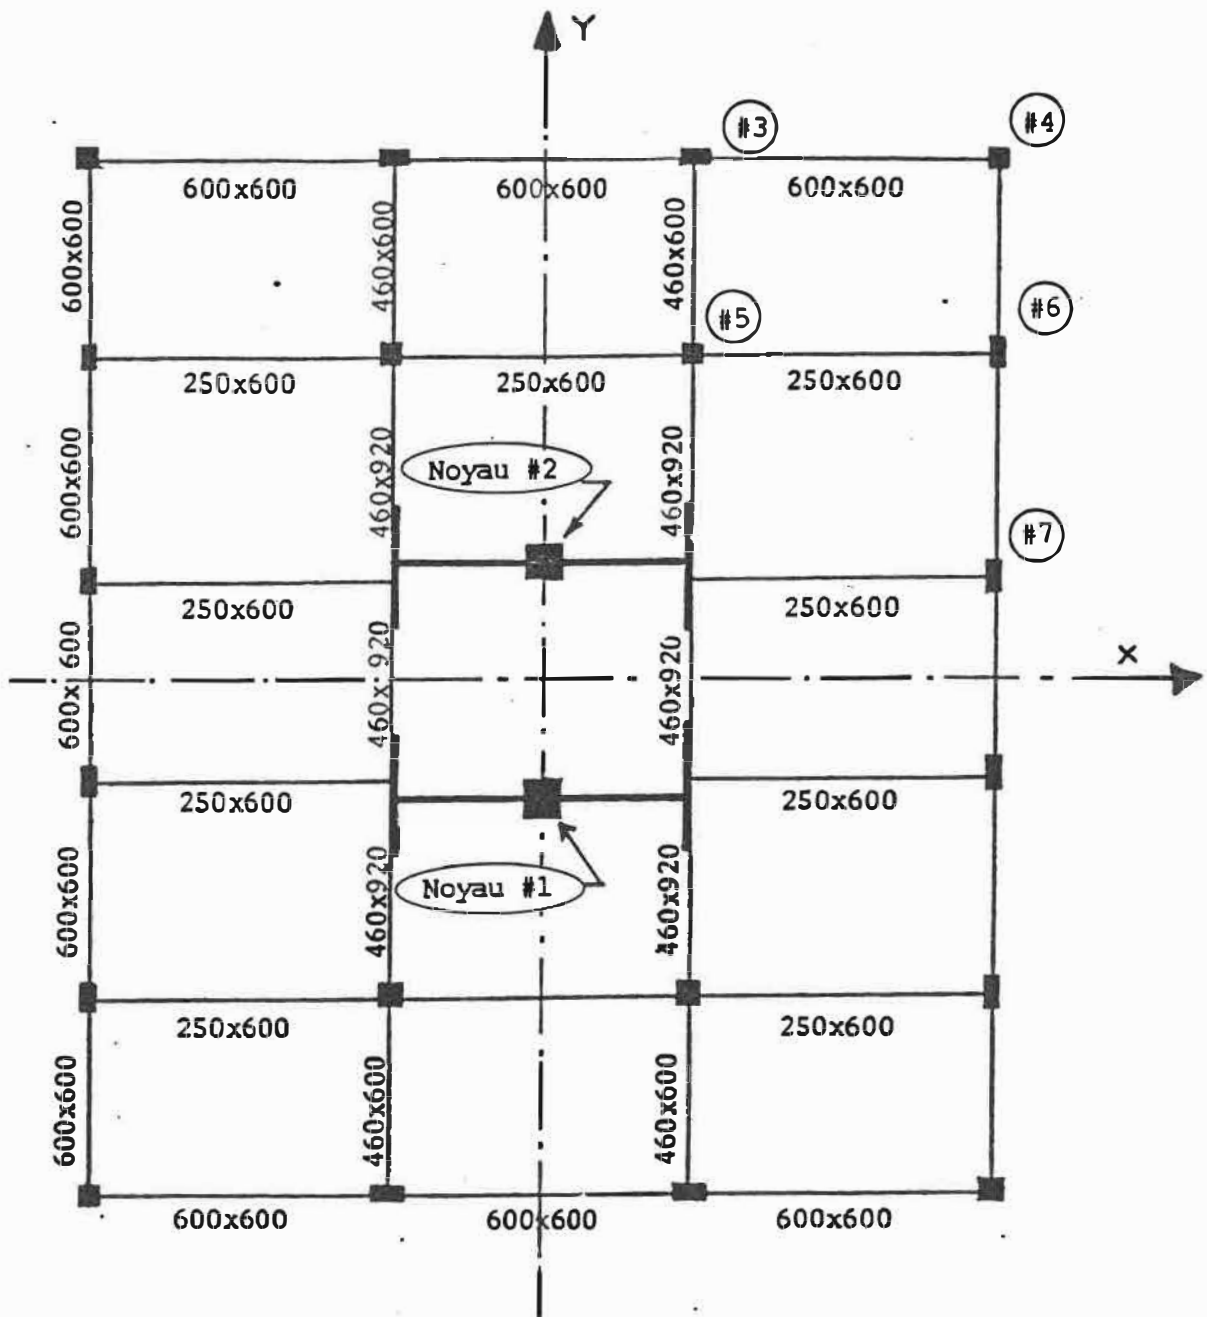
Vue en plan d'un plancher typique du modèle de l'exemple 2.
